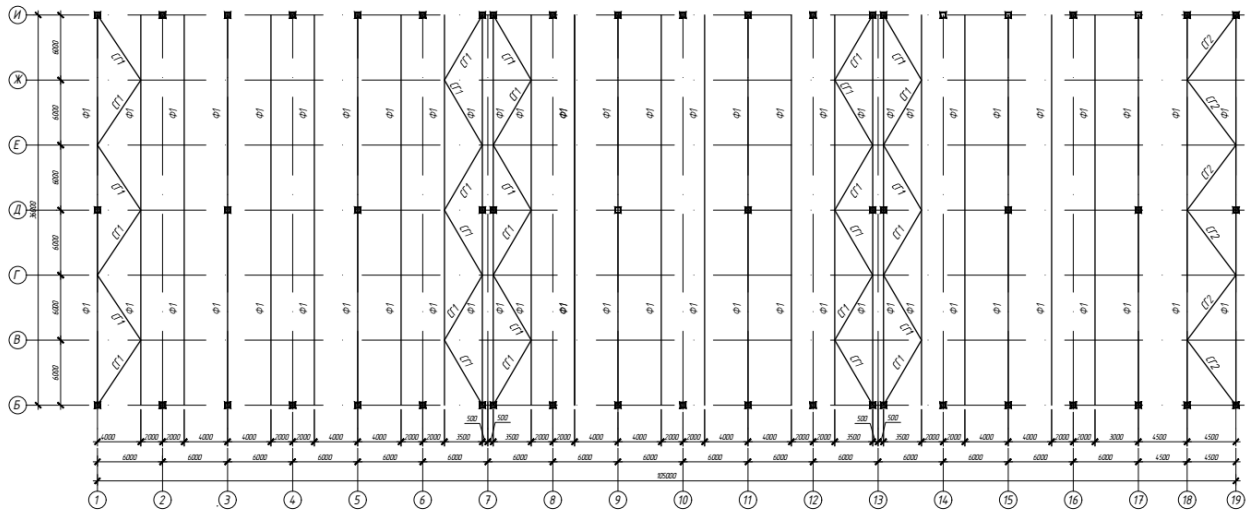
Схема расположения связей по верхним поясам ферм
